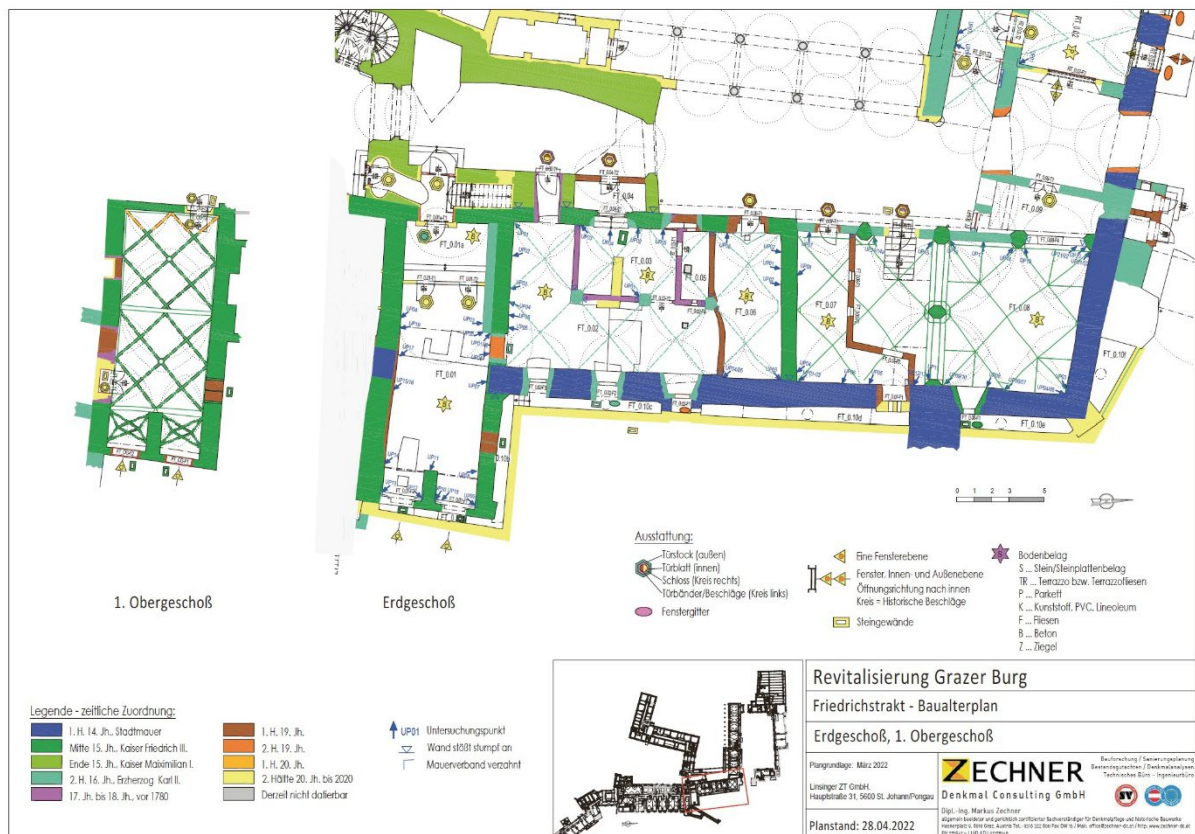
Baualtersplan des Friedrichs- und des Maximiliantrakts, Erdgeschoss und erstes Stockwerk der Kammerkapelle, Zechner Denkmal Consulting GmbH.
